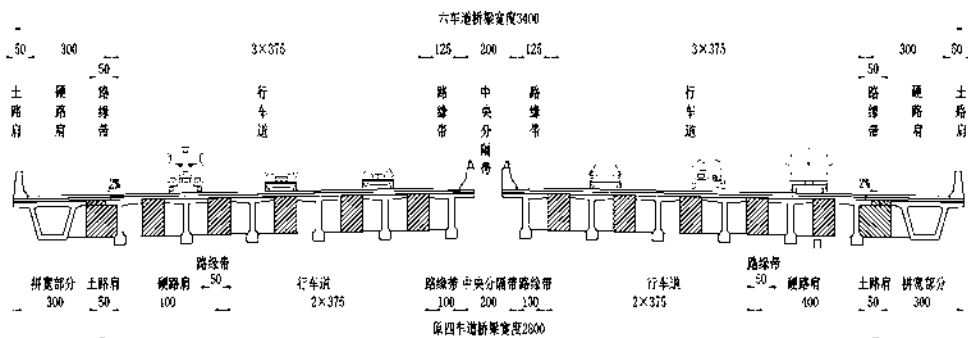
扩建为六车道段桥梁标准横断面示意图（T梁加宽）
